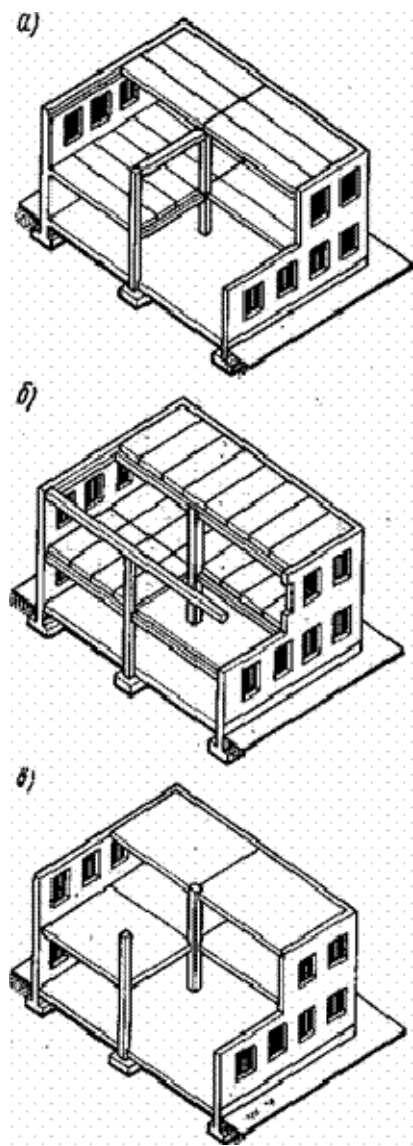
Конструктивные схемы зданий с неполным каркасом: а — с продольным расположением ригелей; б — то же, с поперечным; в — безригельное решение
